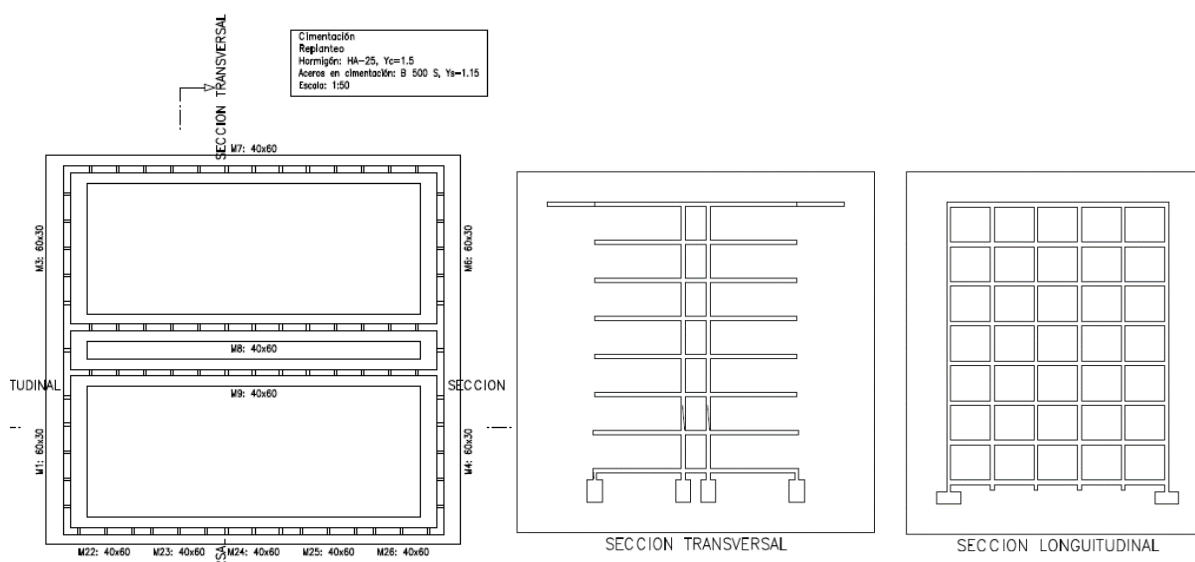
Esquemas en planta y secciones del modelo de nicho analizado.
